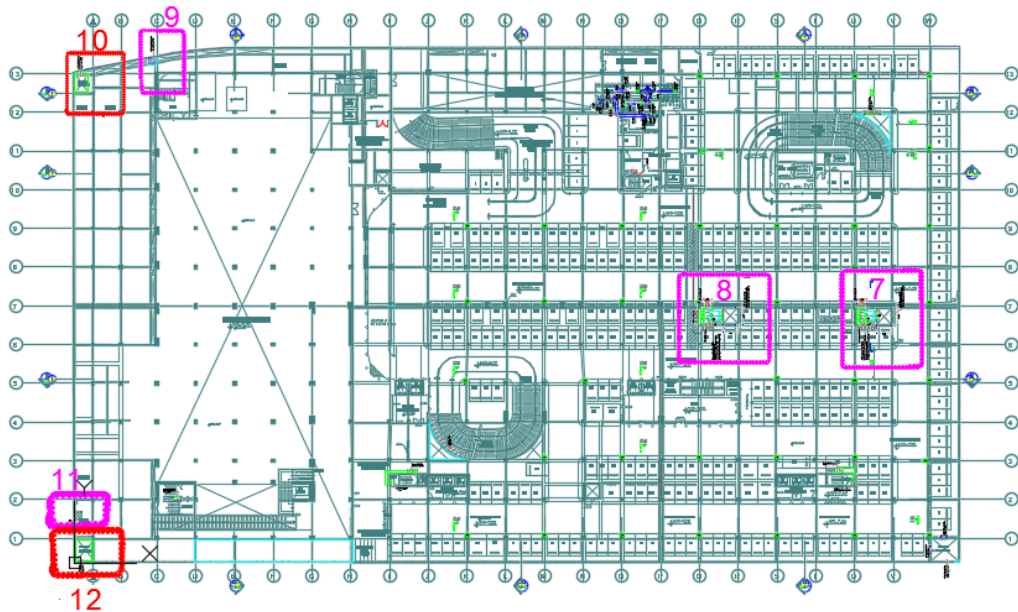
PLANTA GENERAL 1º SÓTANO
